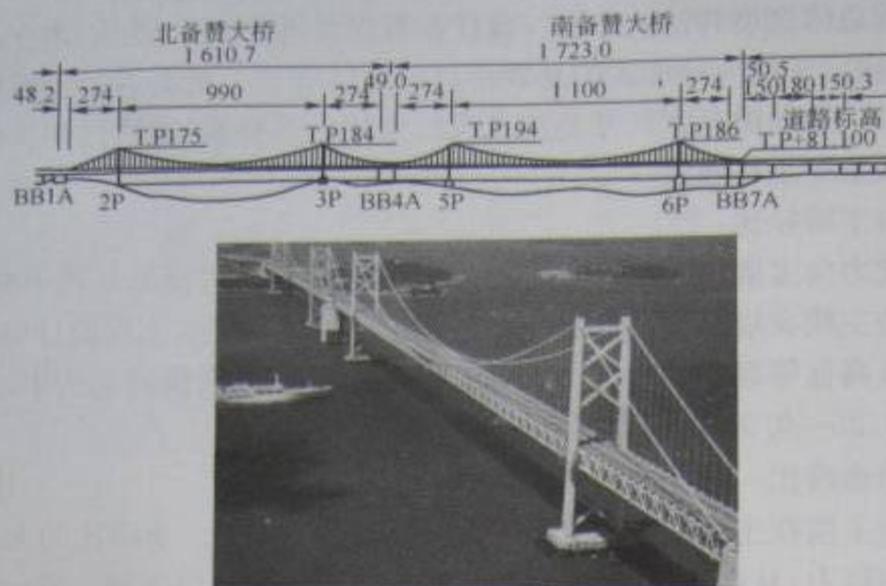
日本南北备赞濑户大桥 (尺寸单位:m)
